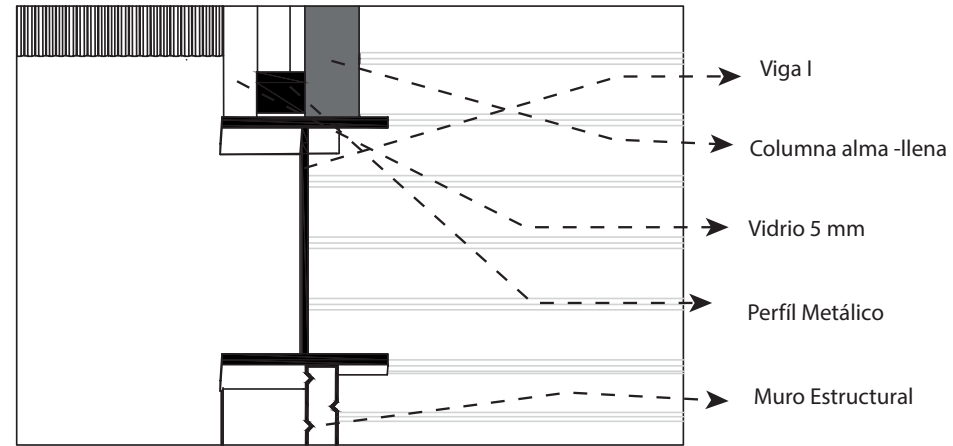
/ Detalle Constructivo Unión entre Muros / Gráfico Propio
